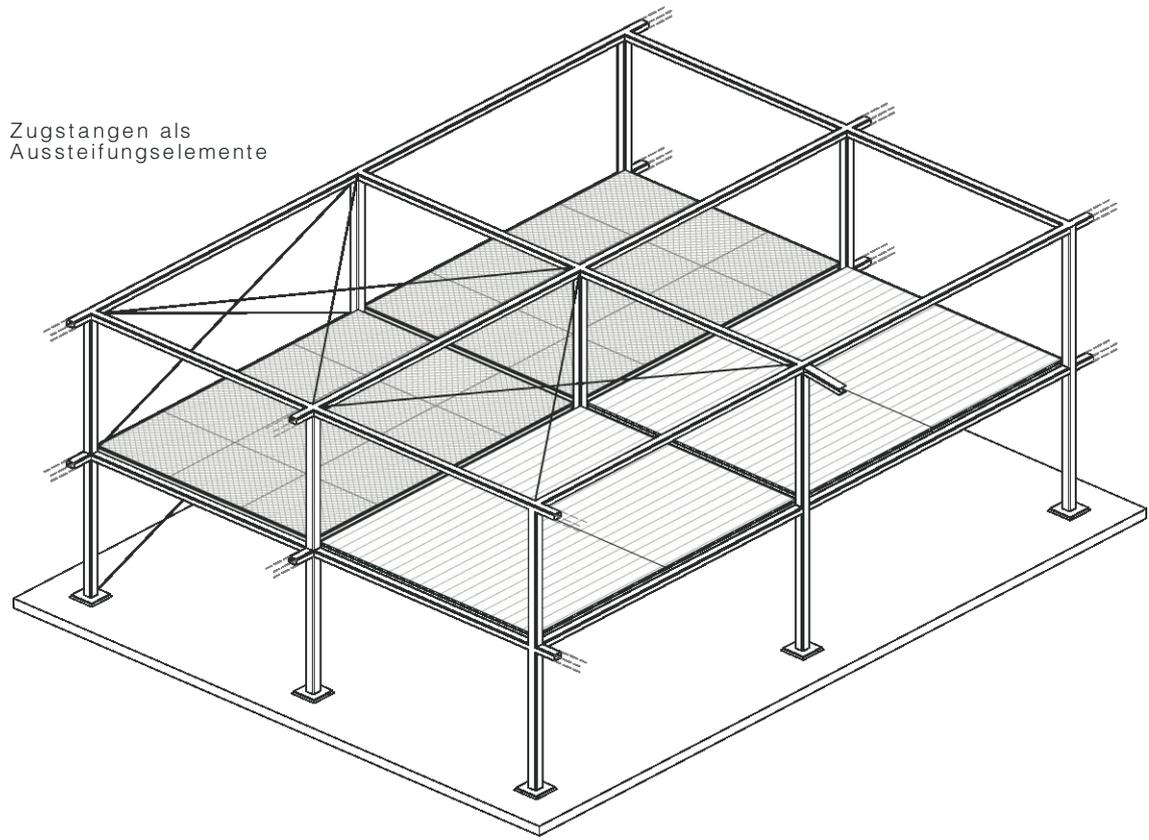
Tragwerk mit horizontalen und vertikalen Aussteifungselementen
